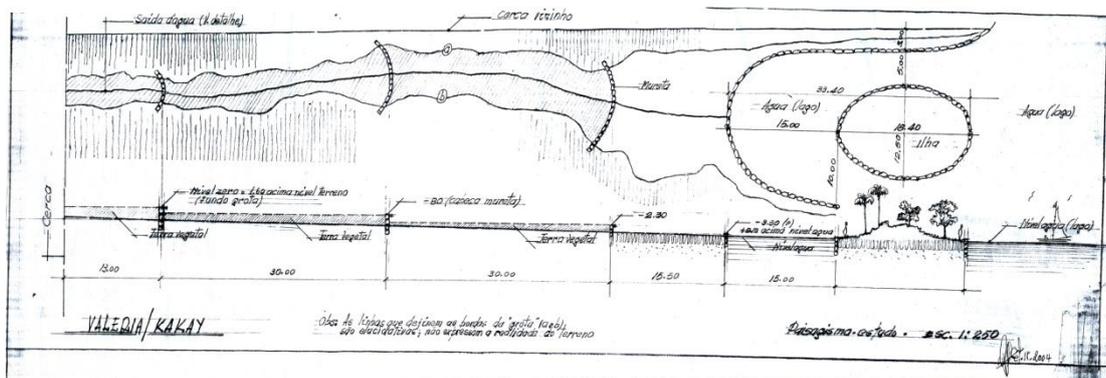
Planta e perfil longitudinal do projeto de revitalização das margens do Lago Paranoá (Fonte: Acervo técnico do paisagista Ney Ururahy)
